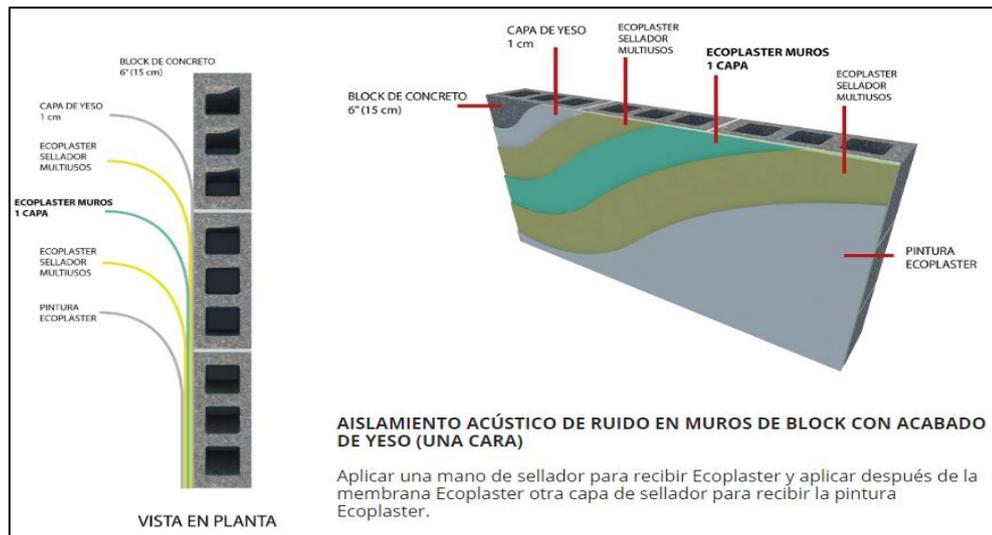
Propuesta de Muros de Aislamiento Acústico en Muros
